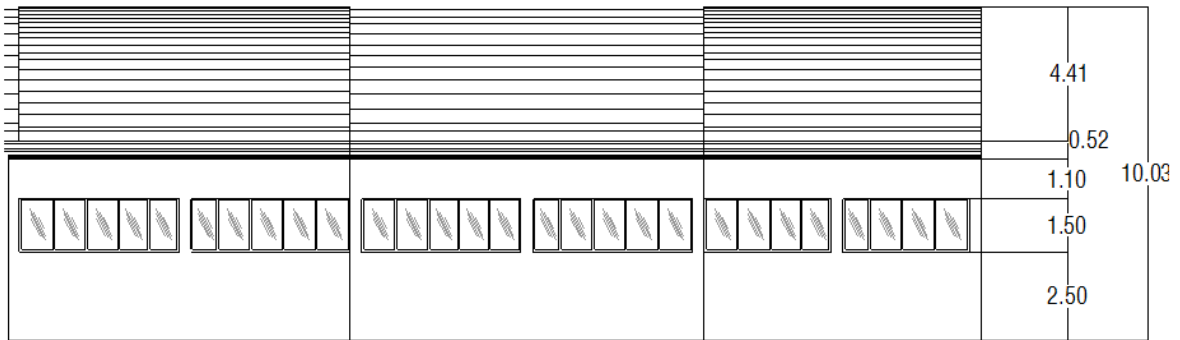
Plano subestación de ayudas visuales AICM (fachada posterior).
